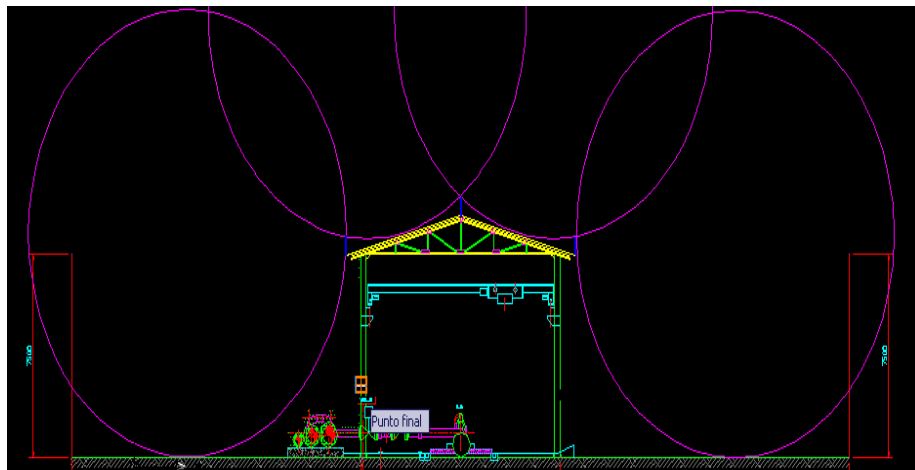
Estructuras Mesa y Merrey protegidas de ancho.
